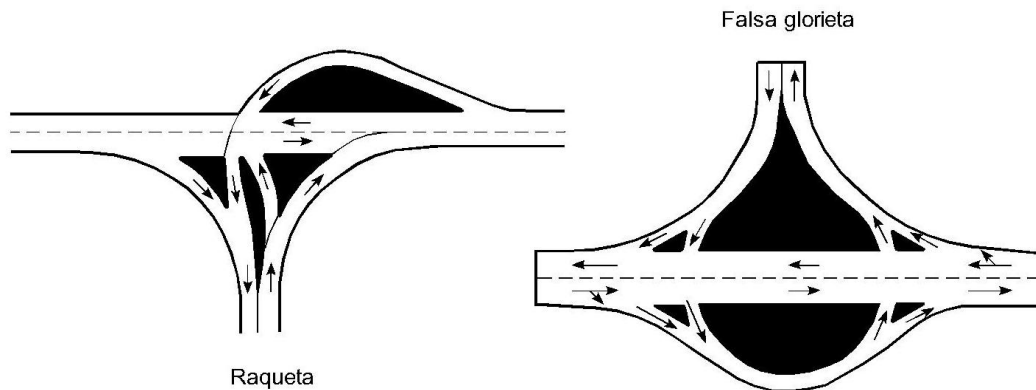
Variantes en raqueta y rotonda o falsa glorieta
